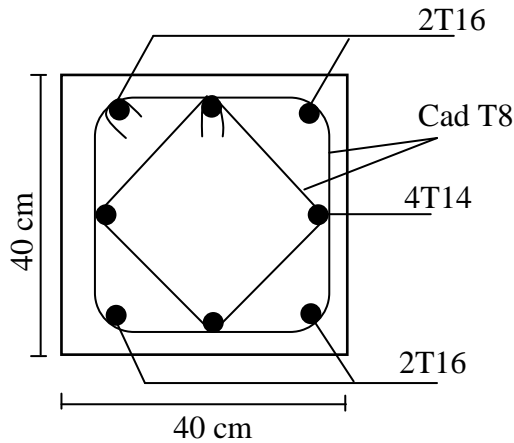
Schéma de ferrailage des sections des poteaux
